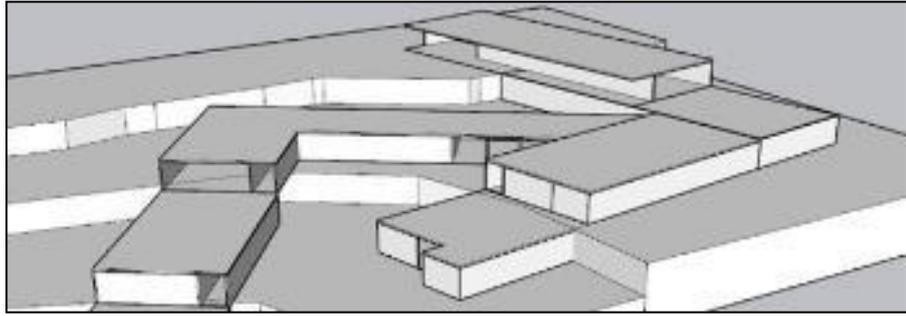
Vista de Planta del proyecto: Distribución de volumetría
